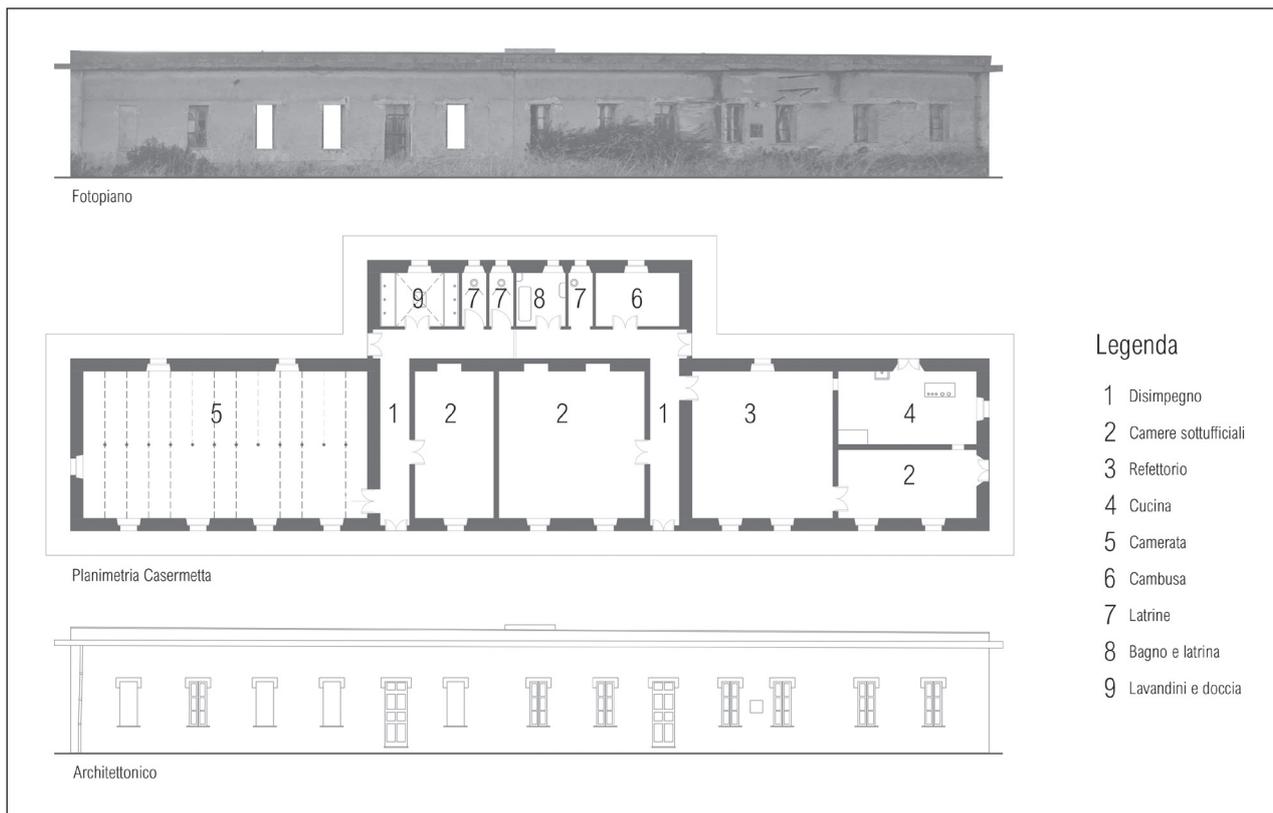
Nora, Base militare ex Stazione R.G. Casermetta truppa, planimetria con destinazione d'uso storico degli ambienti, fotopiano e restituzione grafica del prospetto ovest.
